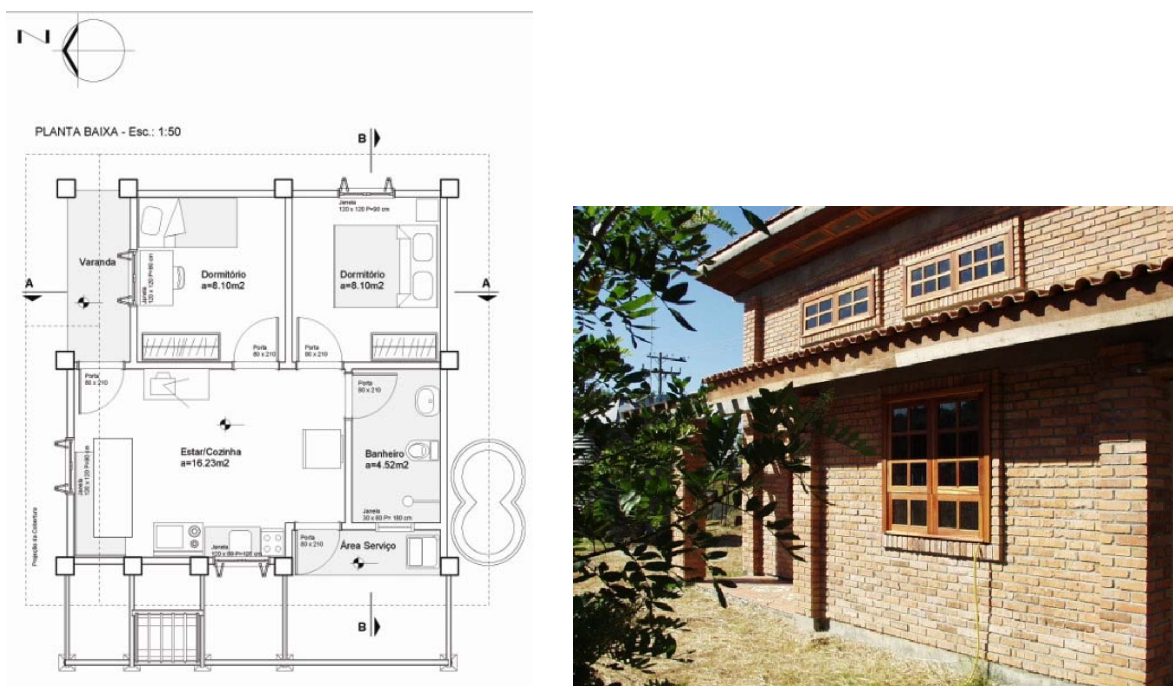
PLANTA BAIXA E FOTO DA FACHADA NORTE DA CASA ALVORADA
